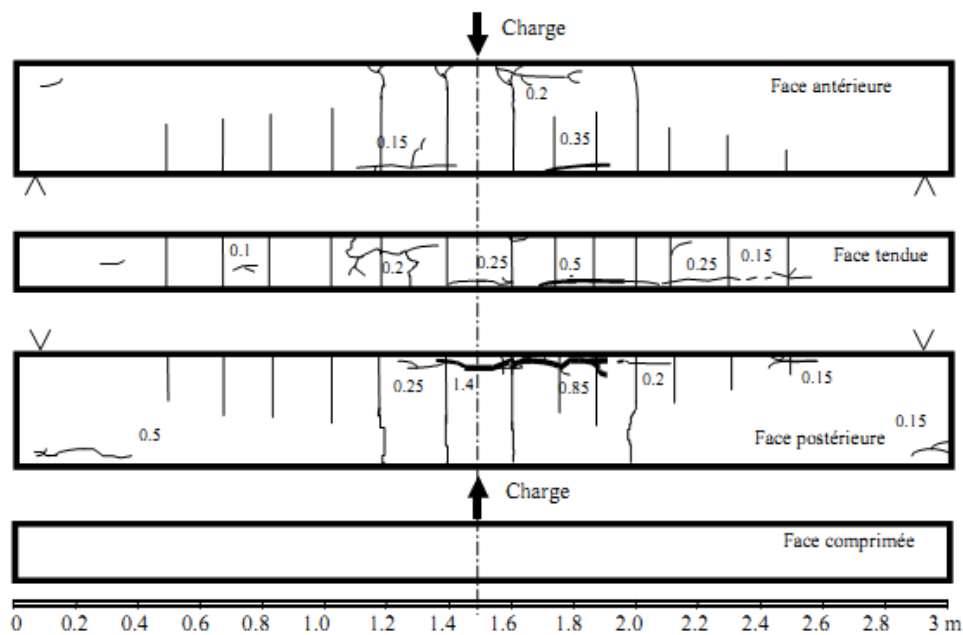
Carte de fissuration à 14 ans de la poutre B1C11 avec les ouvertures des fissures de corrosion en mm.
